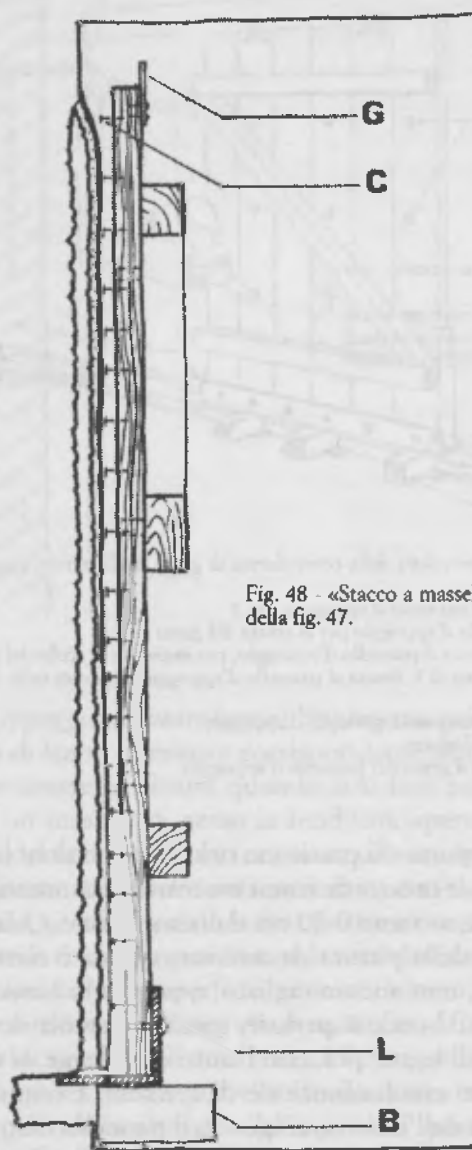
«Stacco a massello»: Sezione verticale della fig. 47.
